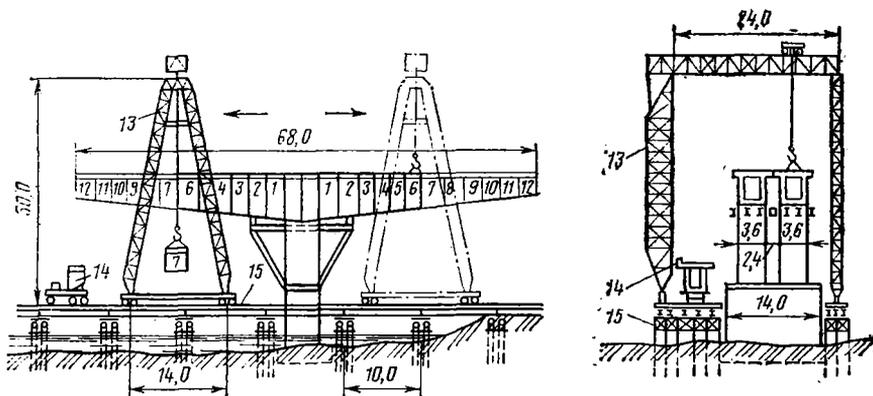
Схема навесной сборки консолей козловым краном:
